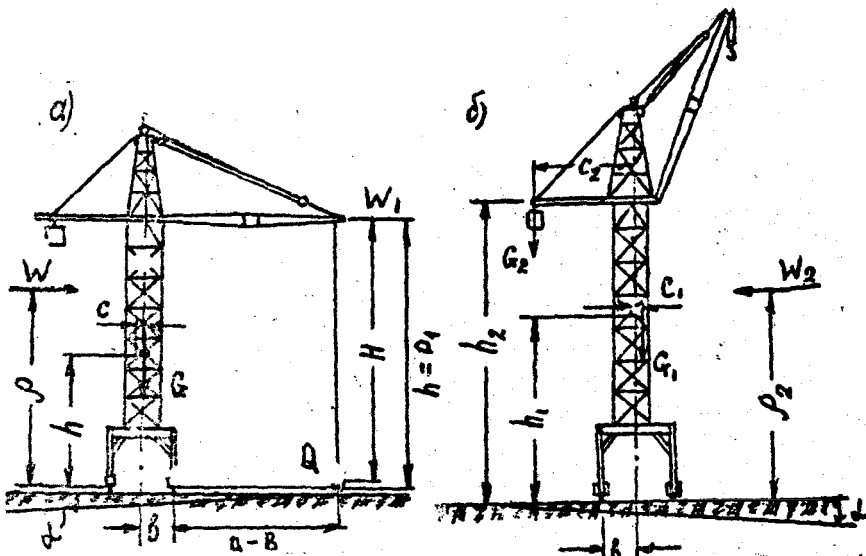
Расчетная схема устойчивости башенного крана: а - с грузом; б - без груза
